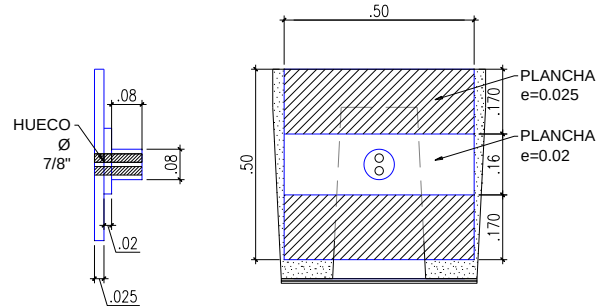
Sección transversal reforzada con plancha de anclaje en tablero de Puente (m).
